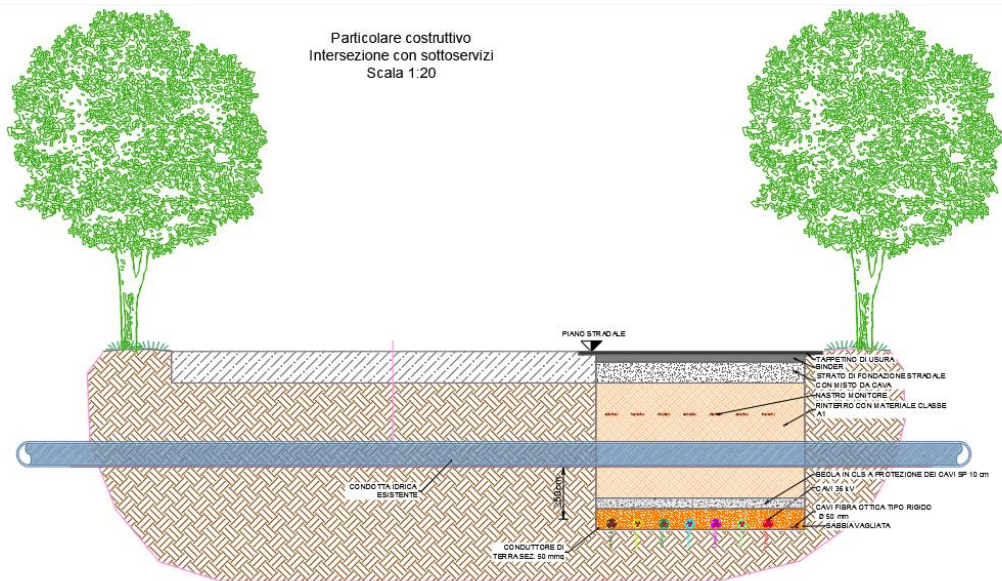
Sezione trasversale tipologica intersezione Cavidotto 36 kV con condotta acquedotto
